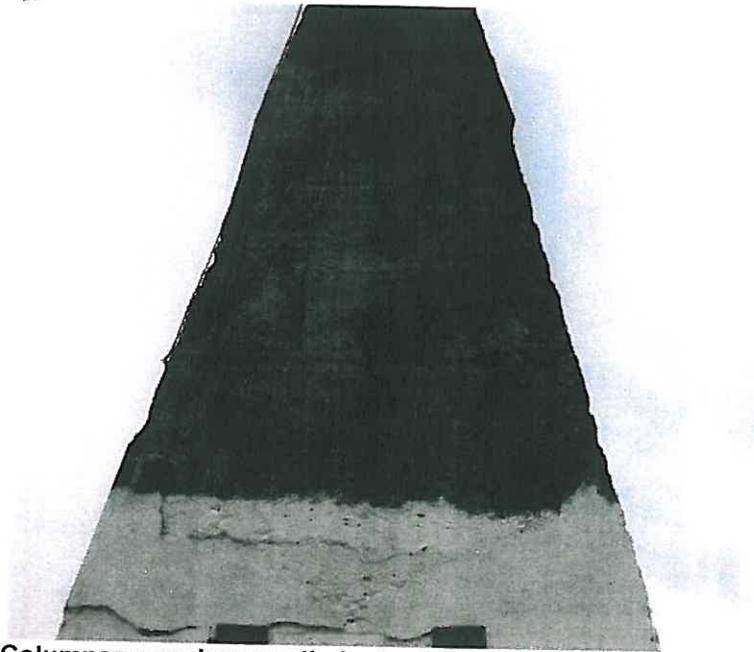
Columnas con desprendimiento de hormigón por corrosión de armaduras.
